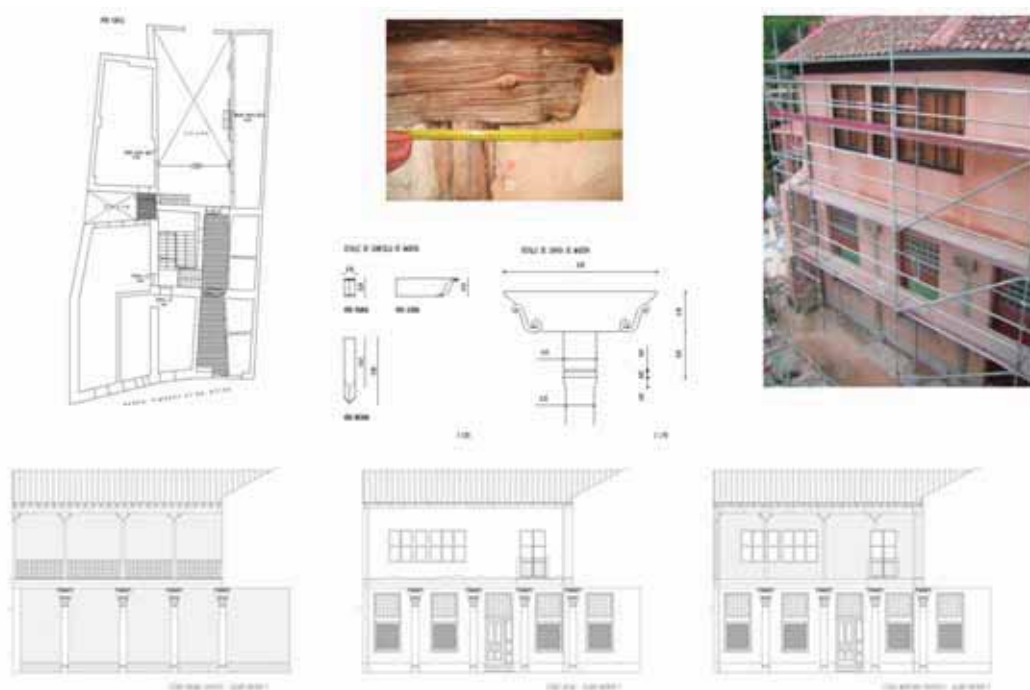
Patio Casa de los Madrigal. Hoy casa de 10 vecinos. En la parte inferior de la imagen Sección-Alzado del patio porticado. De izquierda a derecha: Supuesta configuración Original. Estado Previo a adecuación de fachada. Estado después de la intervención.
